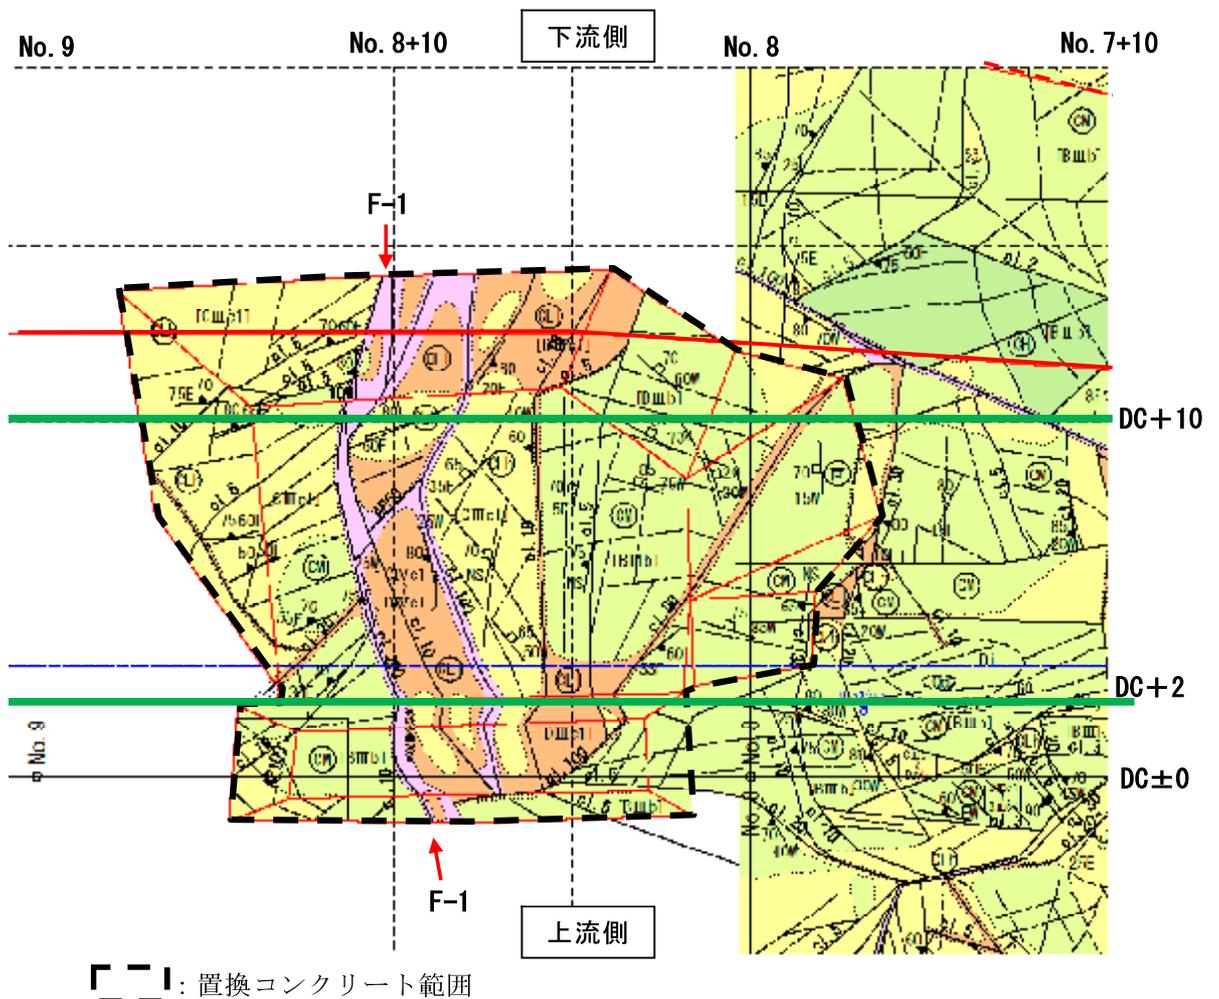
F-1 断層置換コンクリート部掘削平面図(岩級区分)
